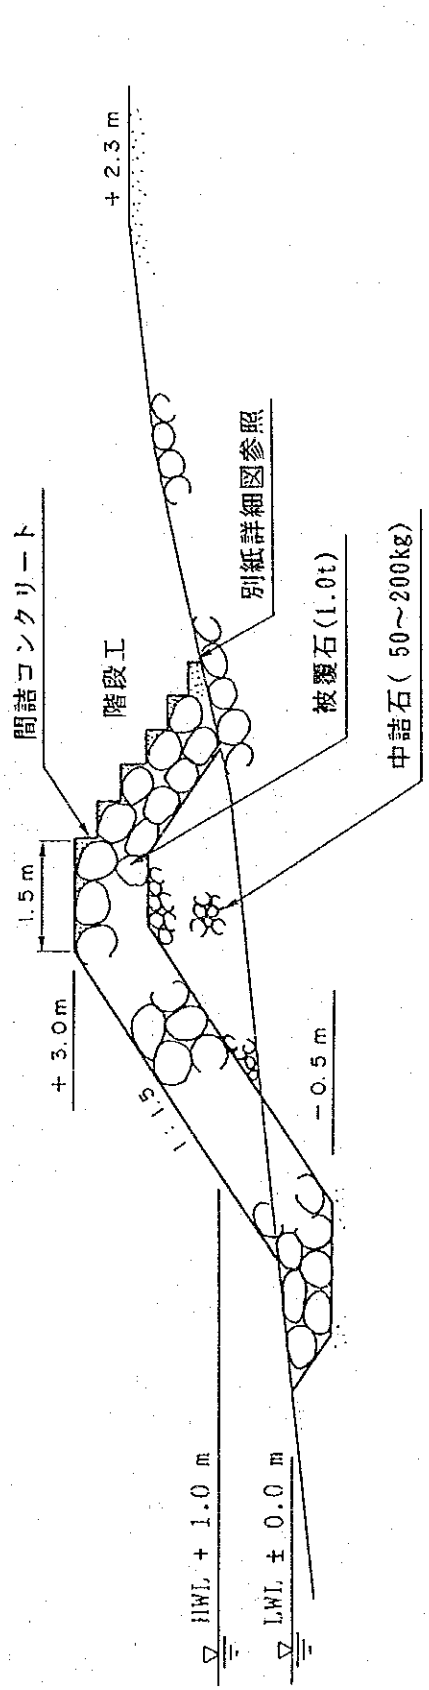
海岸保全施設、標準断面図 (A - B 区間)
